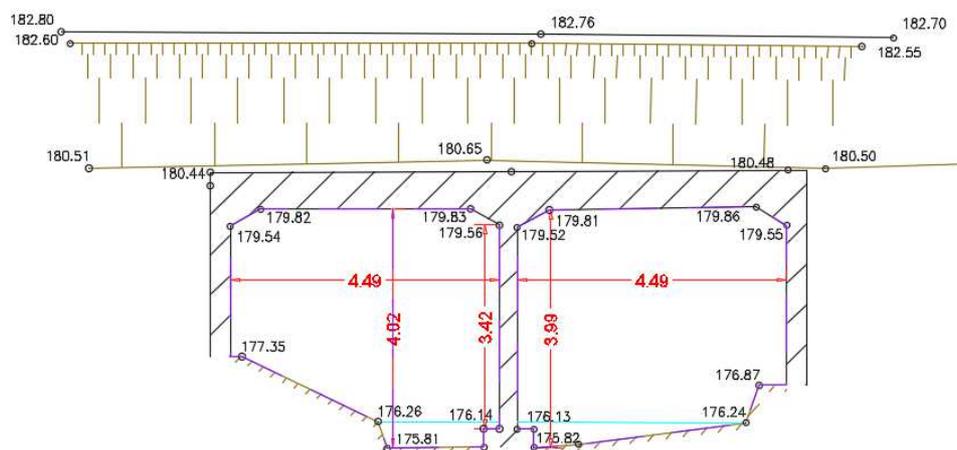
Dimensions de l'ouvrage cadre sous la digue
